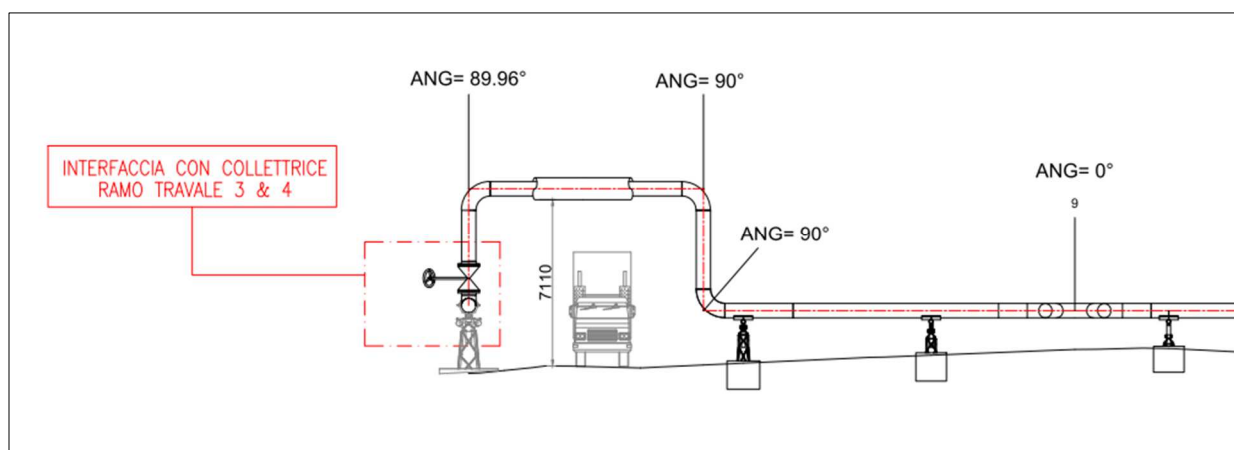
P1 – stralcio da elaborato GRE.EEC.D.28.IT.G.13405.27.053 foglio 2/02, zona di attraversamento della strada vicinale di Travale
